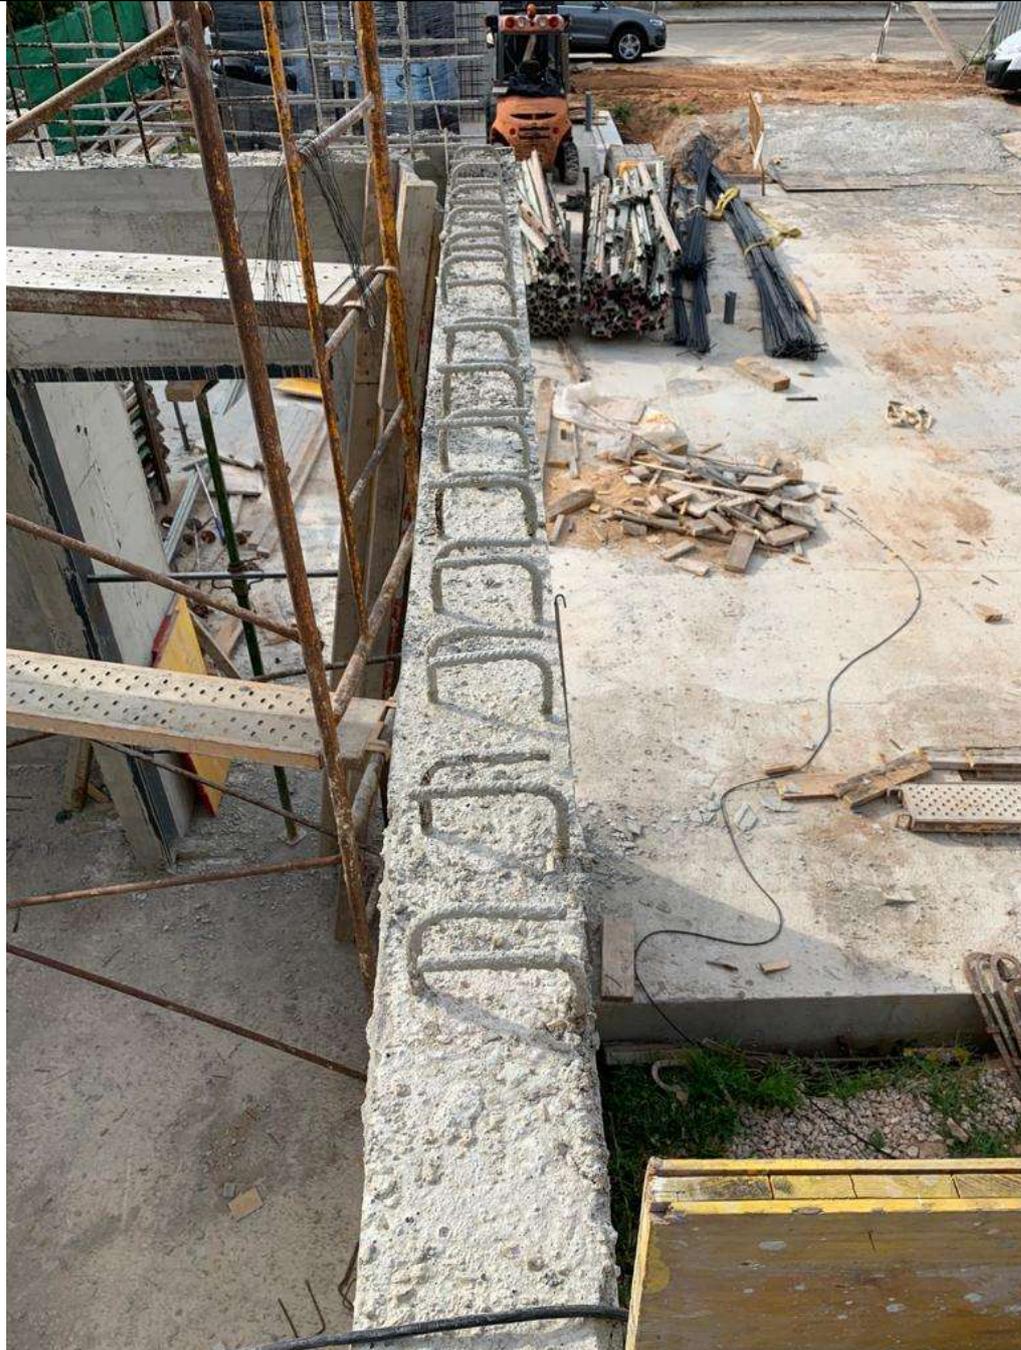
Armado desplazado de muro hormigón. 2020. Fuente propia
